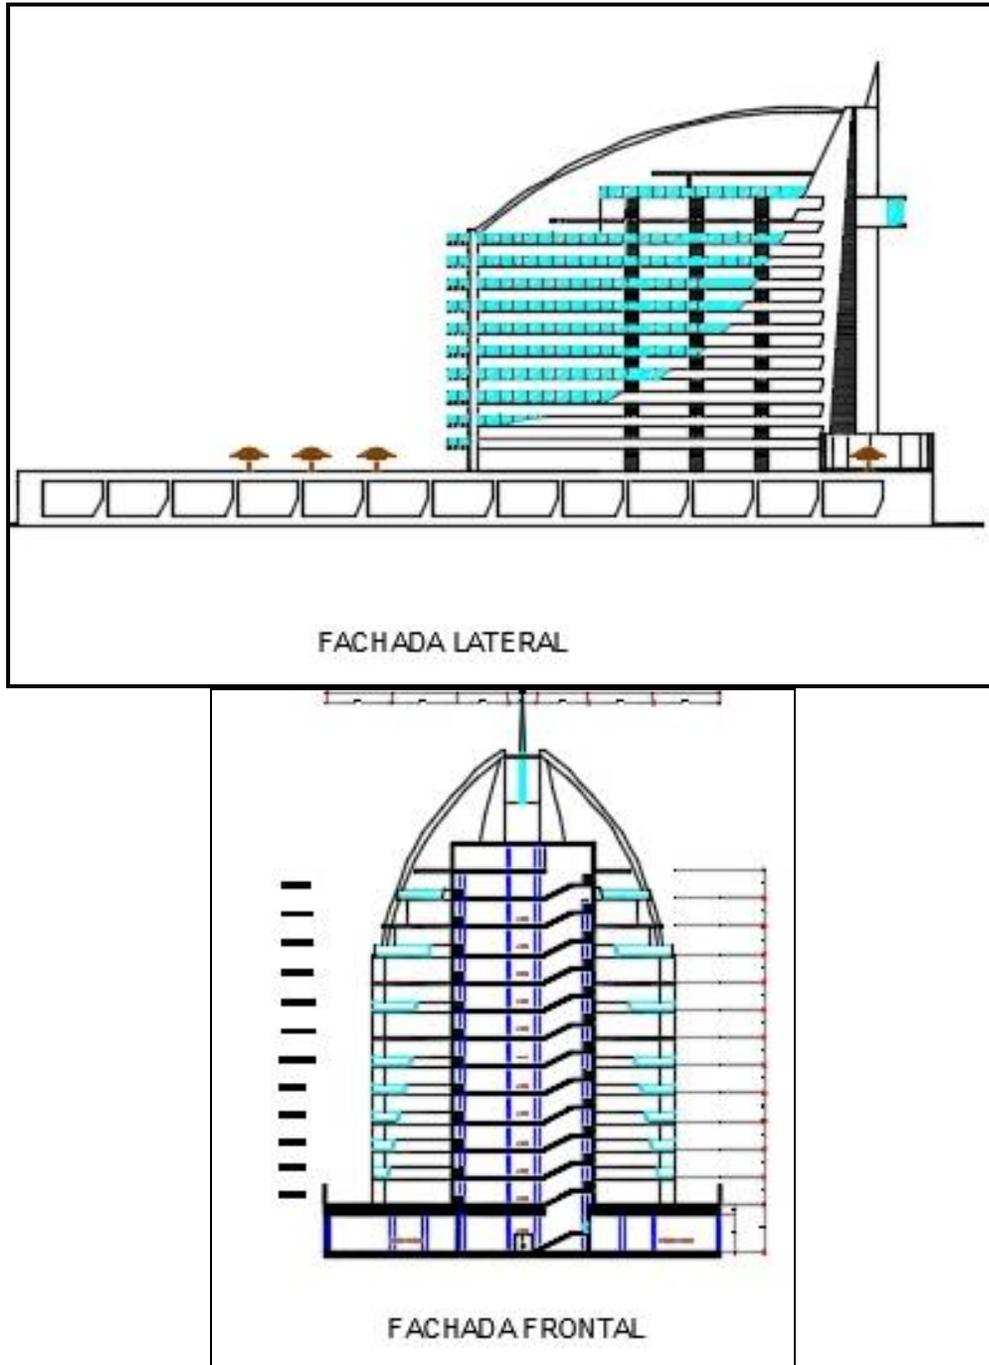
PLANO DEL PROYECTO FACHADA LATERAL Y FRONTAL
